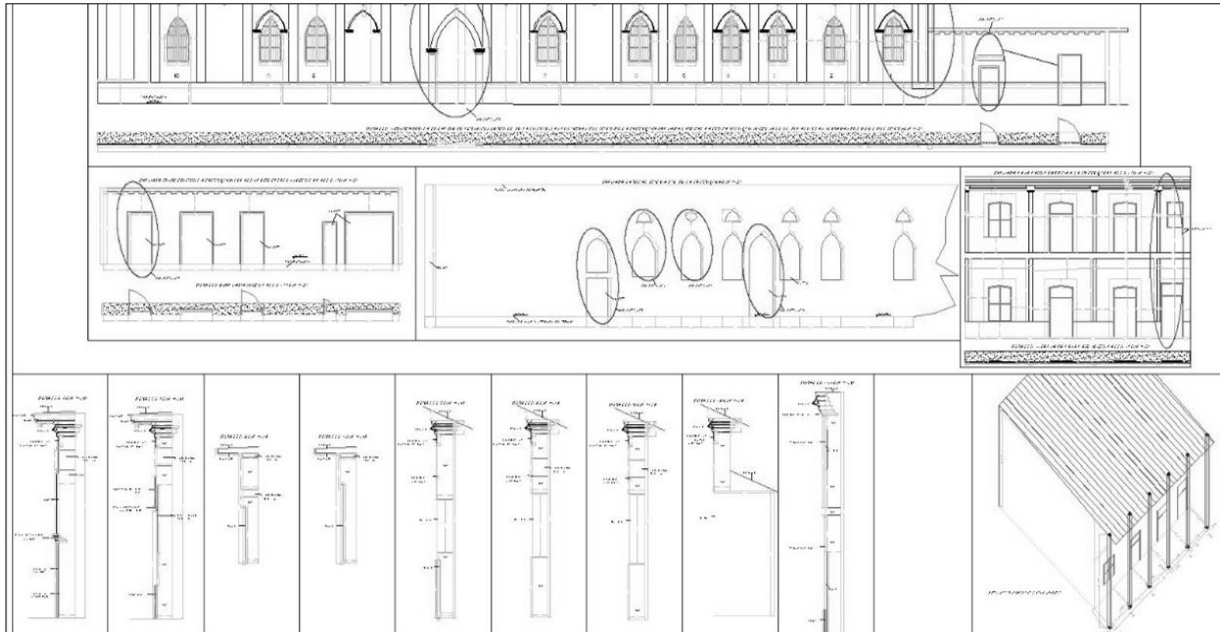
Levantamiento Topográfico y Arquitectónico Fachadas Laterales y Muro Interno templo Parroquia San Miguel
